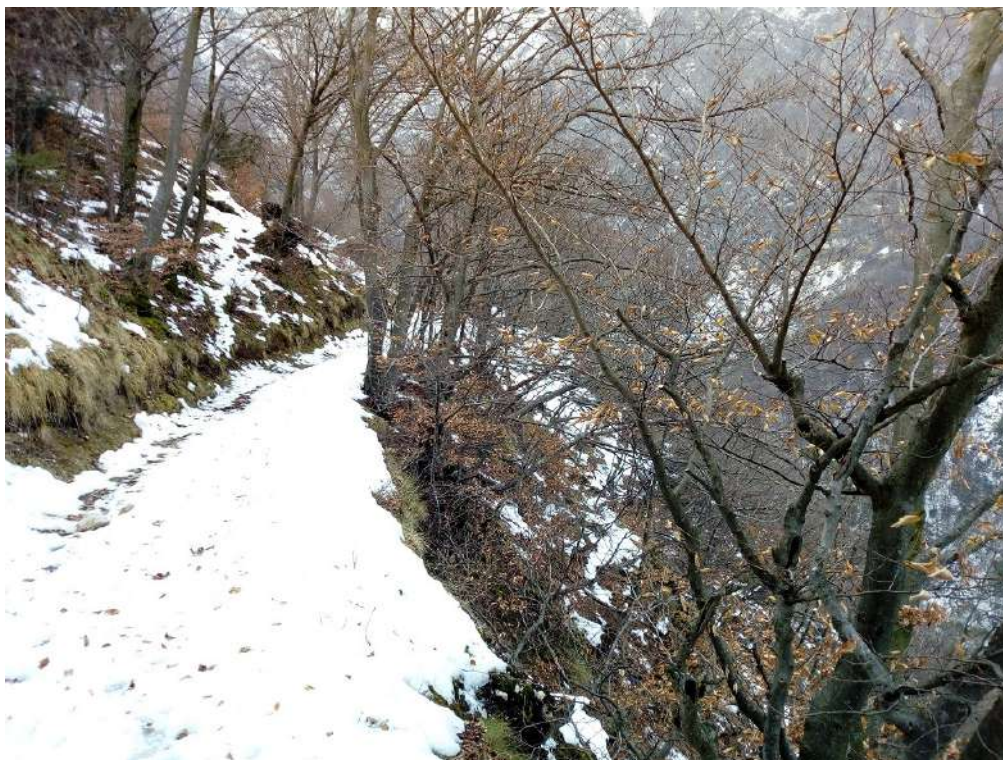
Prosecuzione del tratto pianeggiante dove si prevede la posa del nuovo guardrail. In questo punto erano cadute le piante a causa del vento della tempesta Vaia.
